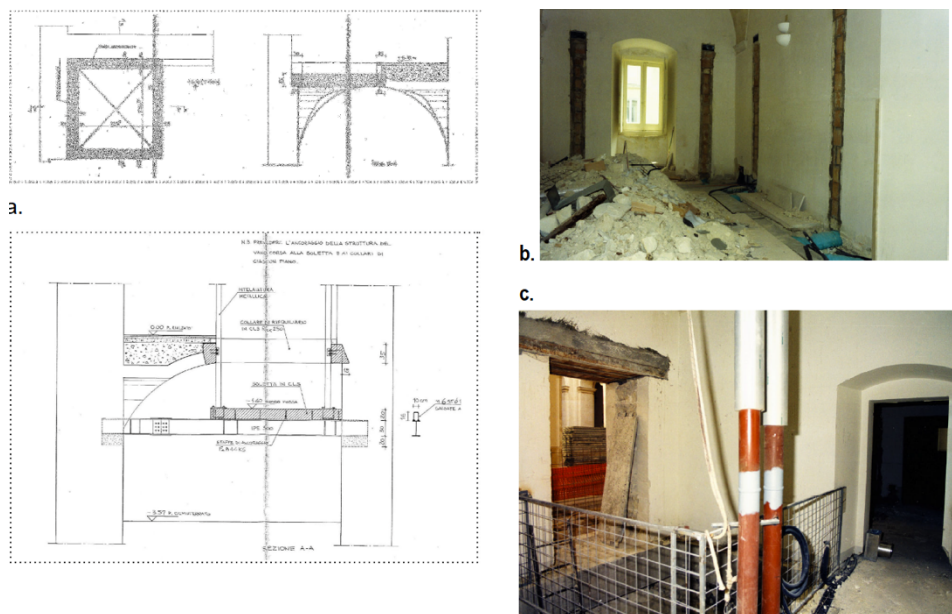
Progetto di adeguamento impiantistico, foto di cantiere (Fototeca del Museo dell'Arte Medievale e Moderna della Basilicata in Palazzo Lanfranchi).
